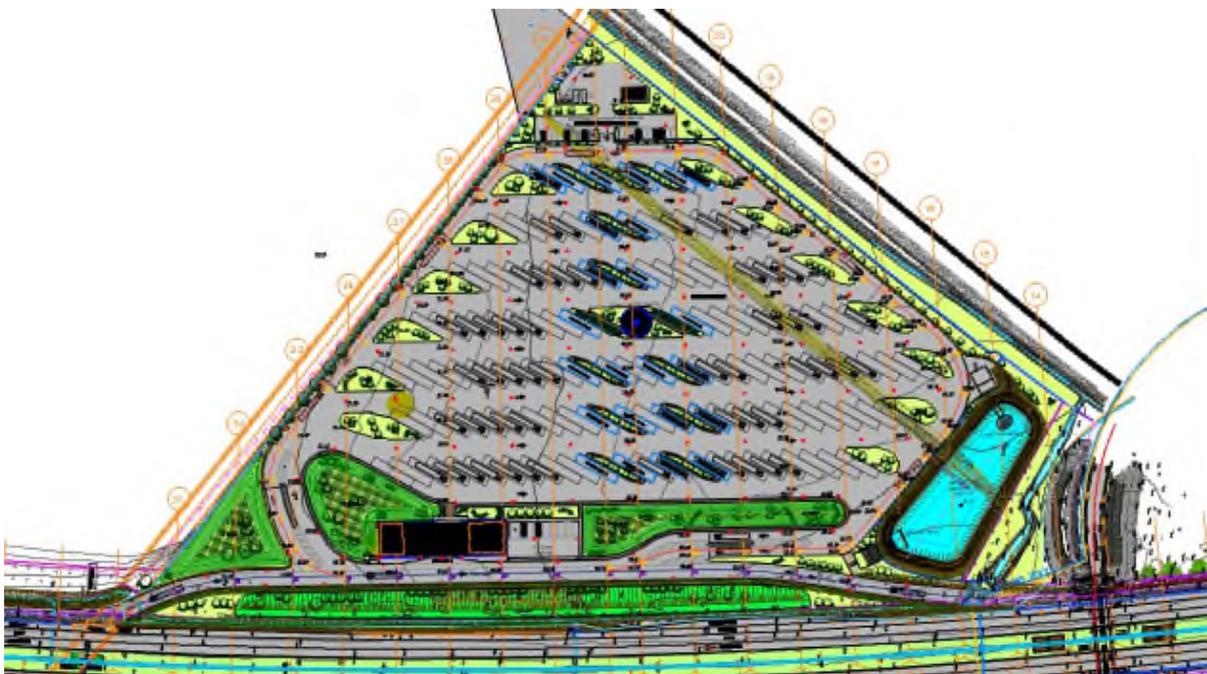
Planimetria di Progetto – Area di Sosta
